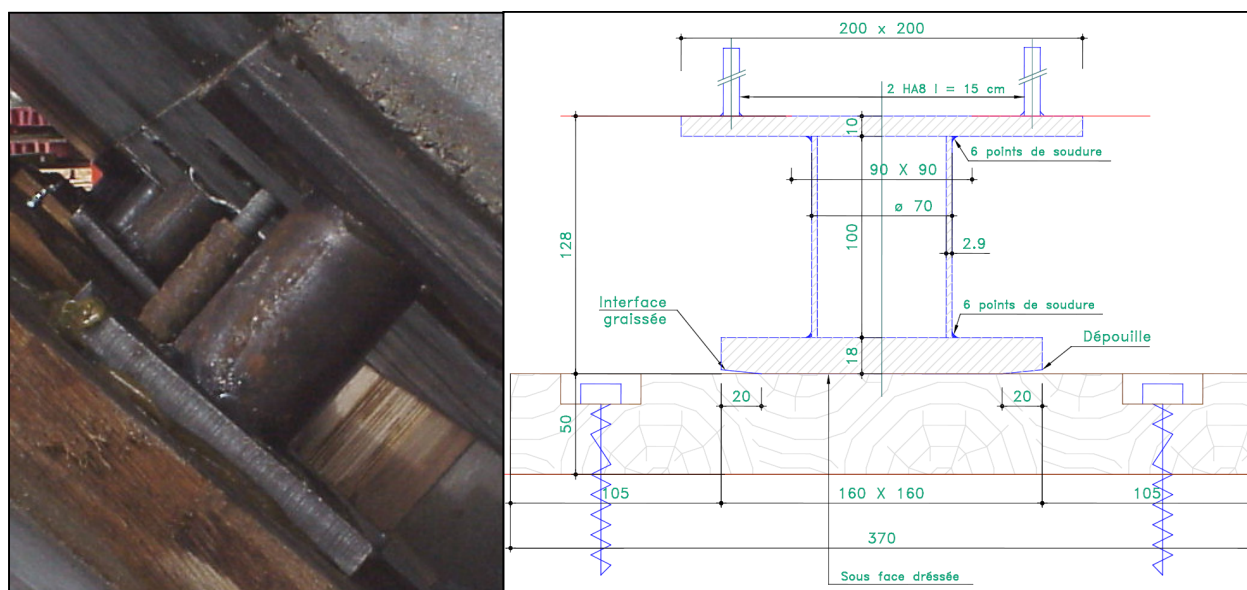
photographie et coupe verticale d'un appui fusible de la dalle d'essai inclinée
